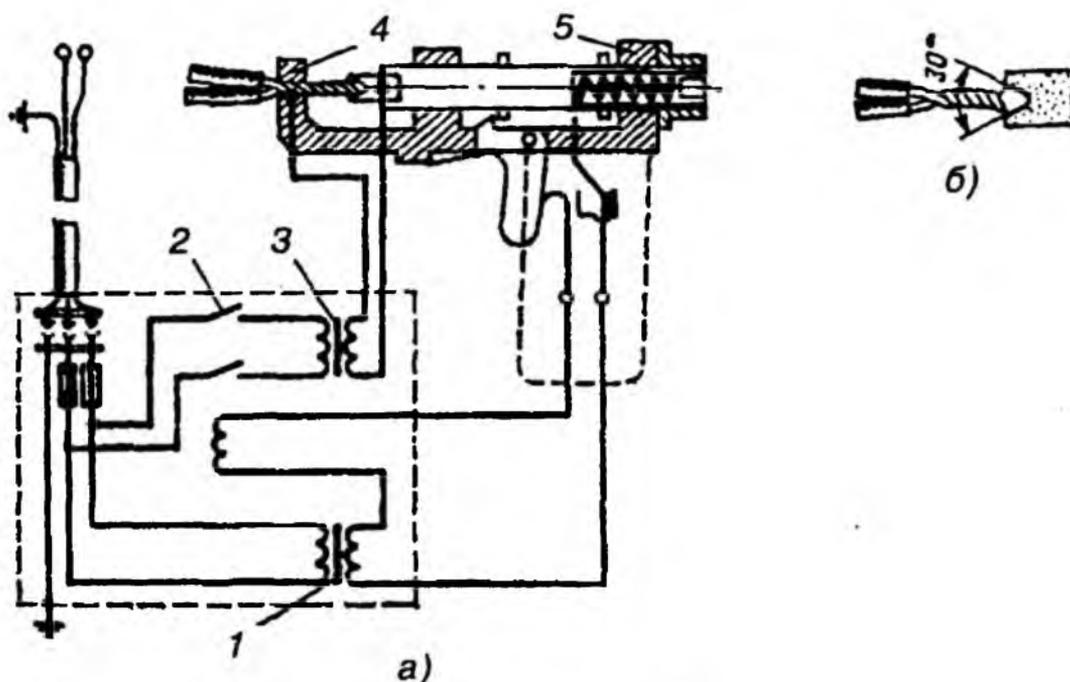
Схема автоматической сварки контактным разогревом алюминиевых жил с применением аппарата ВКЗ:
